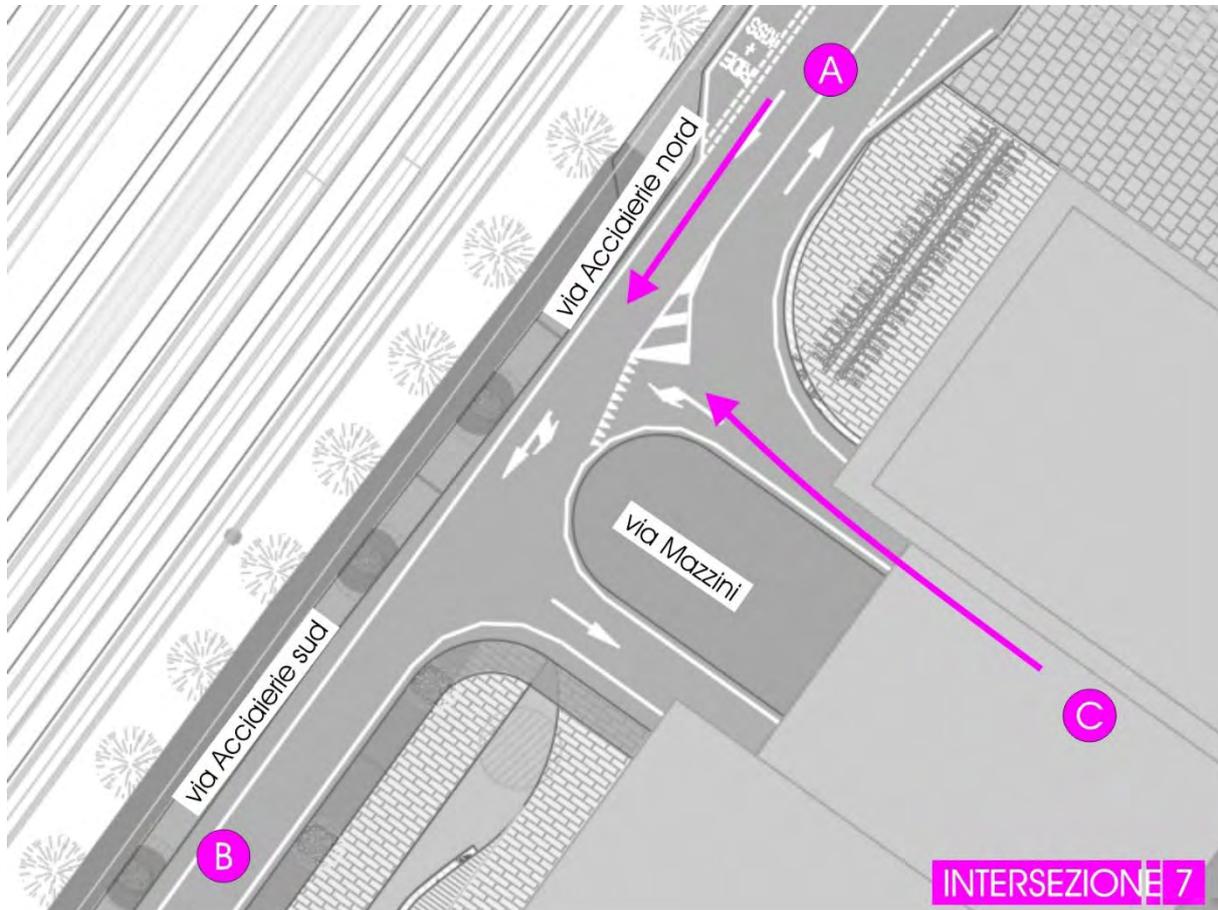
Scenario di Intervento 2 – Planimetria intersezione 7
